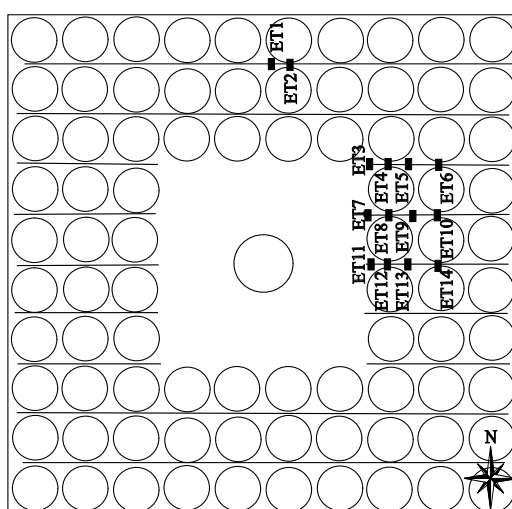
Localização dos extensômetros nas treliças da laje BD-A05
